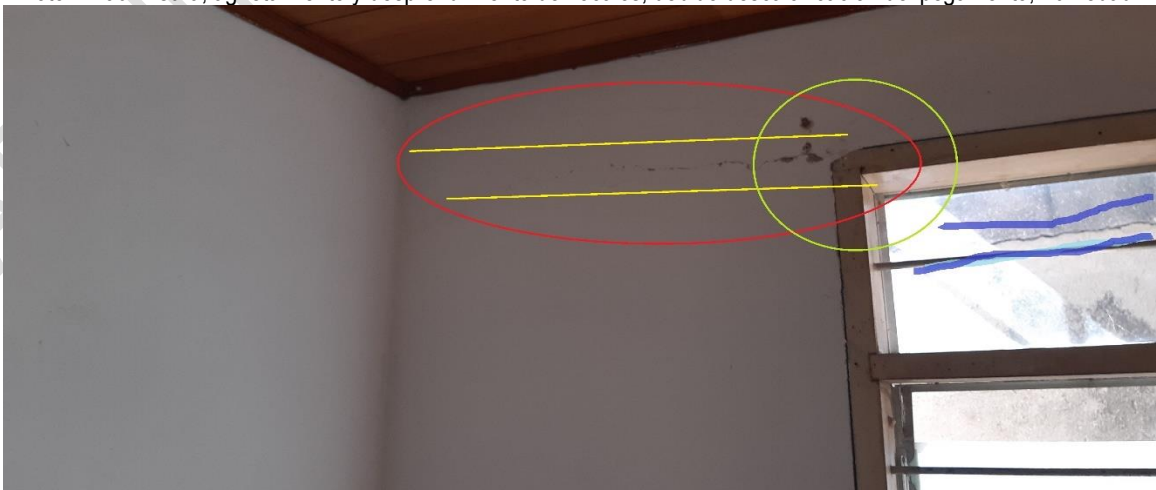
Fisuras y grietas en sentido horizontal, presencia de humedad y desprendimientos de enlucidos.
